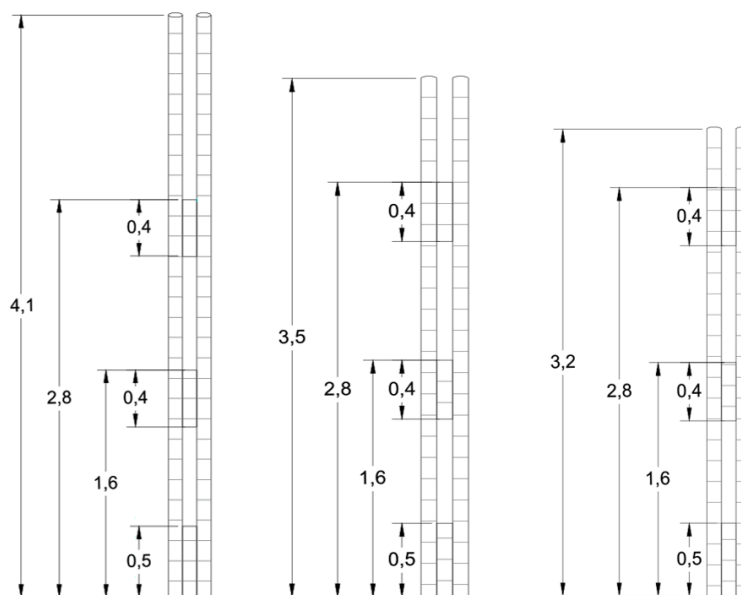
Columnas compuestas dobles. Fuente: Elaboración Propia
